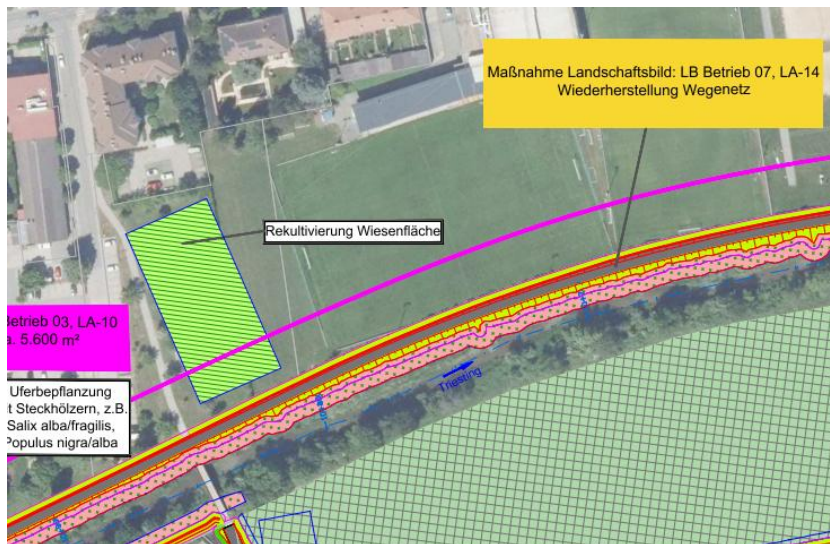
Park am Triestingau Radweg, Ausschnitt OLB Massnahmenplan Blatt 05 Trumau (Quelle: Einreichoperat, Einlage 247E)
